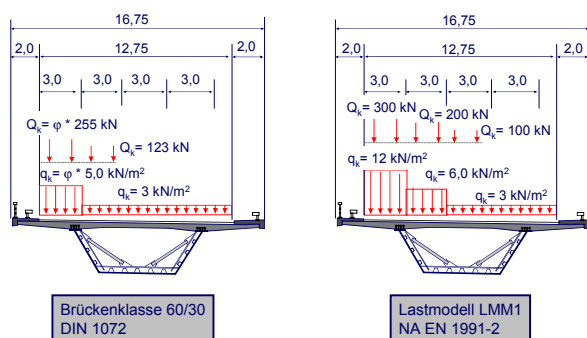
Brückenklasse 60/30 nach DIN 1072 und geplantes modifiziertes Lastmodell LMM1 nach Nationalem Anhang zu DIN EN 1991-2
